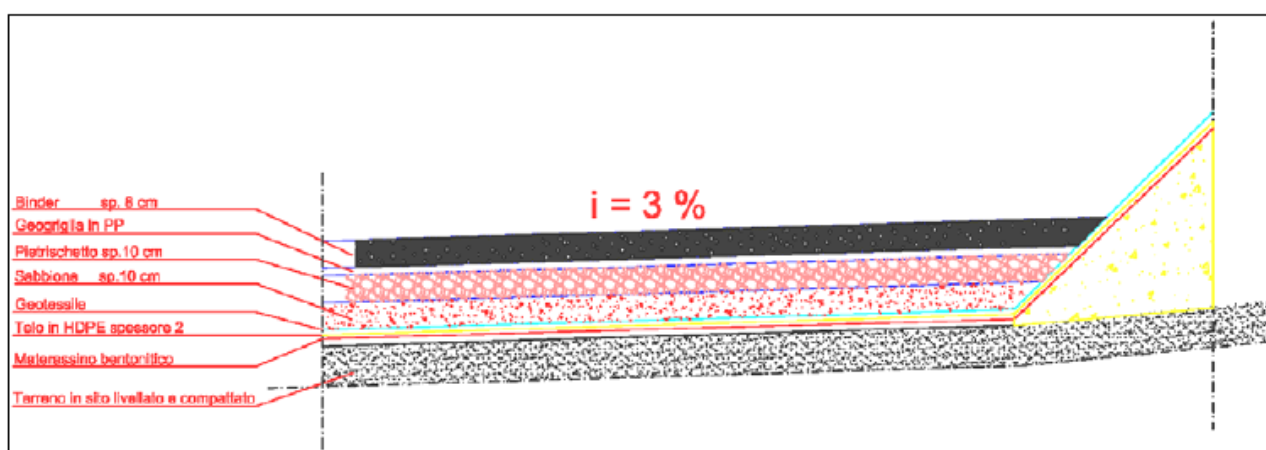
Sezione verticale del sistema di impermeabilizzazione
